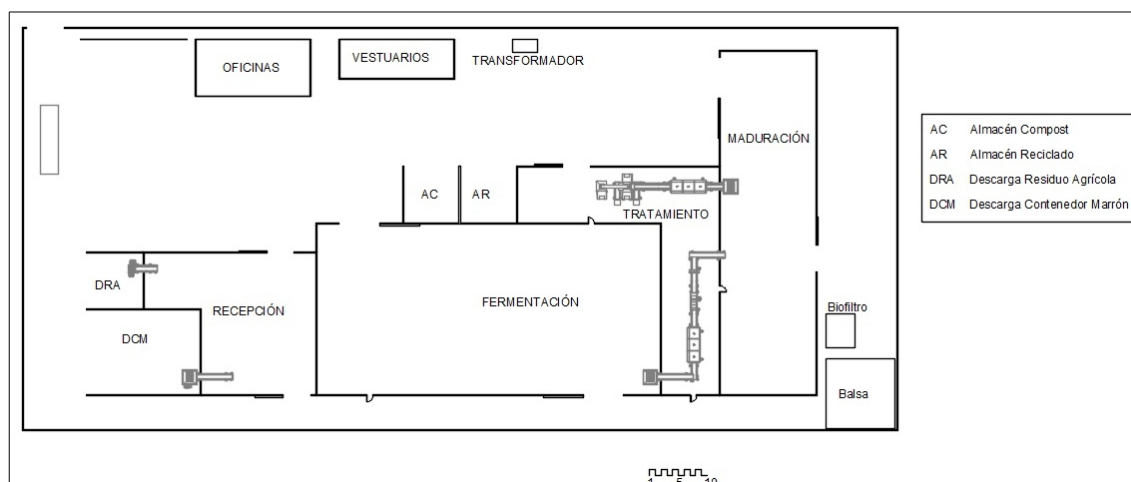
Plano de distribución en planta de las instalaciones. Fuente propia.
